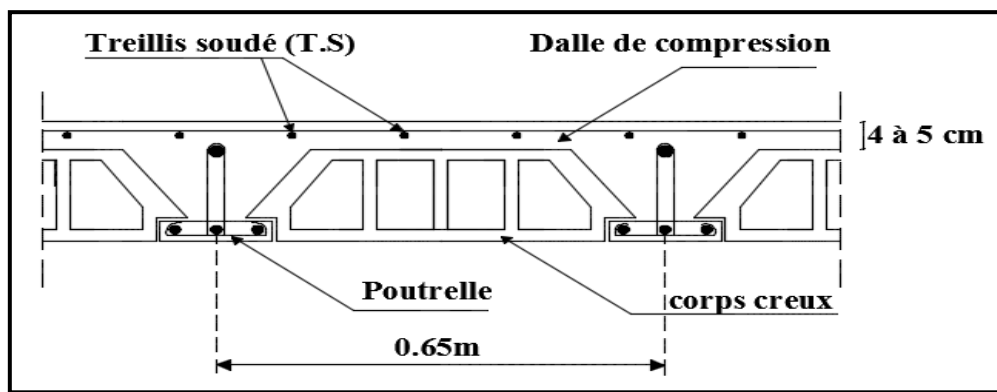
Coupe verticale d'un plancher en corps creux
